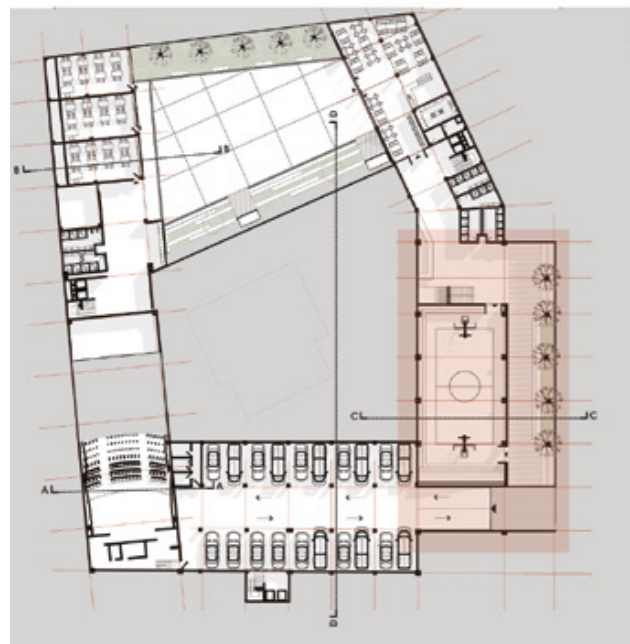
Esquema Planta subsuelo | Fuente: Elaboración propia
